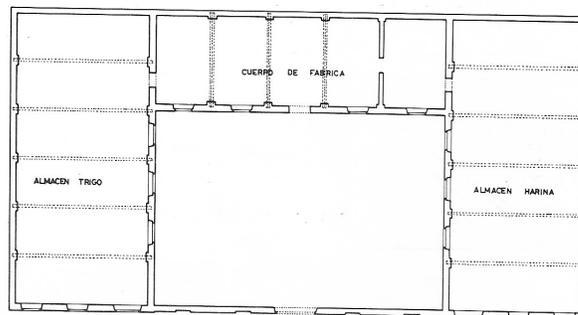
Alzados y distribución en planta de la fábrica de harinas "La Rosa". (CARRERA DE LA RED, Miguel Ángel: 1990: 274-279).
